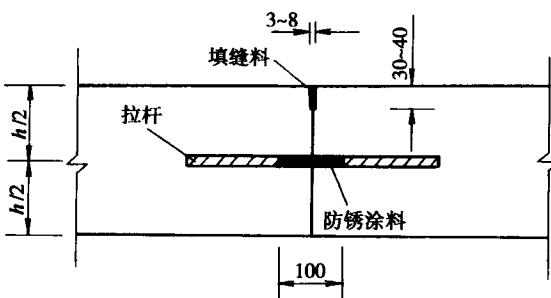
纵向施工缝构造(尺寸单位:mm)
